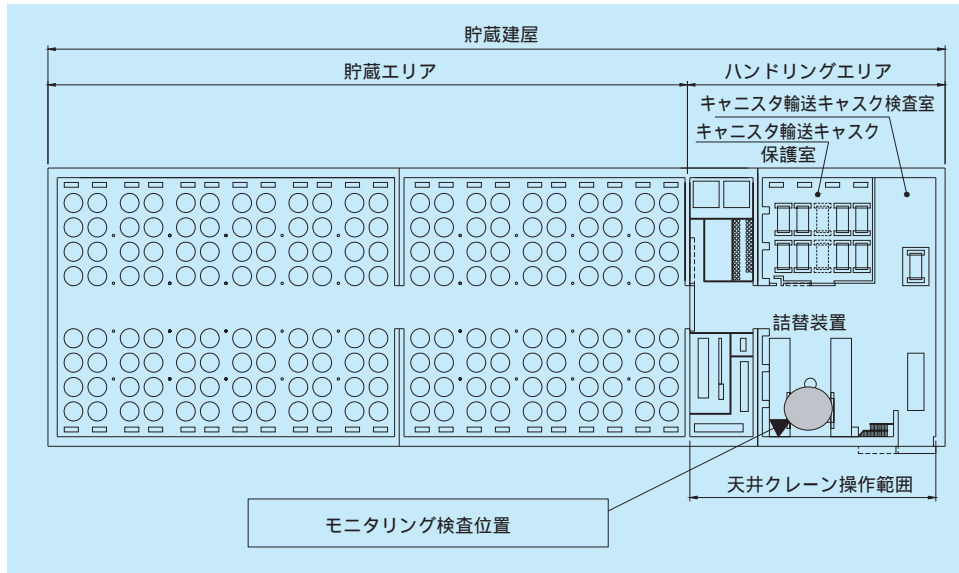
コンクリートカスクの中間貯蔵施設の全体配置図（平面図）とモニタリング検査の適用位置
